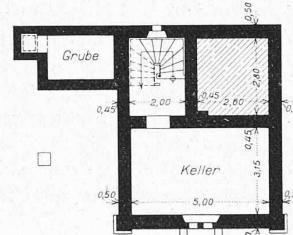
bis 3. Streckenwärter-Wohnhaus. — Grundrisse 1:250.
